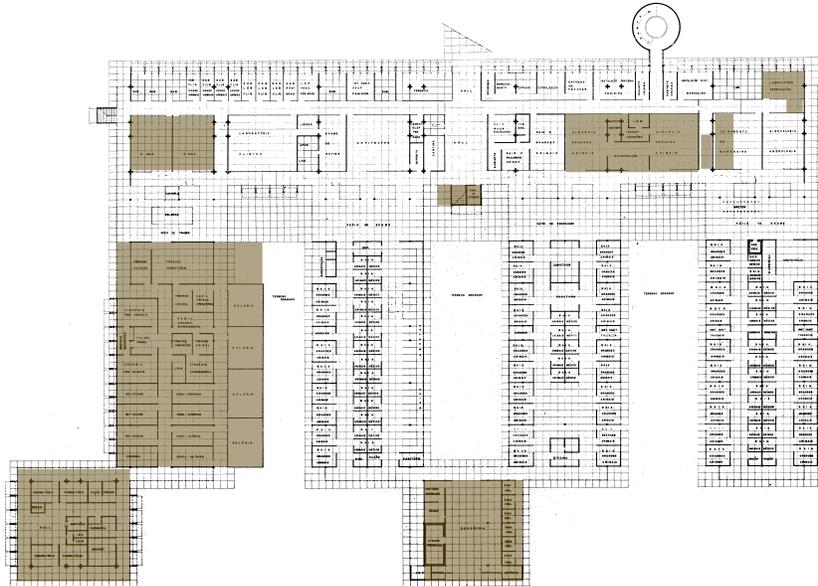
Planta do pavimento térreo, com as áreas de modificações.
